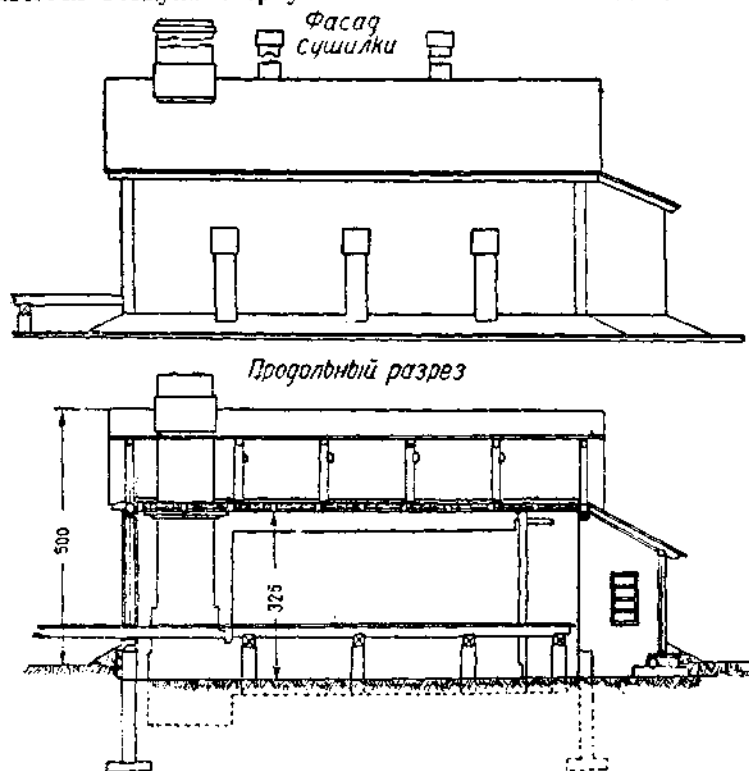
Продольный разрез сушилки ЦНИИМЭ
